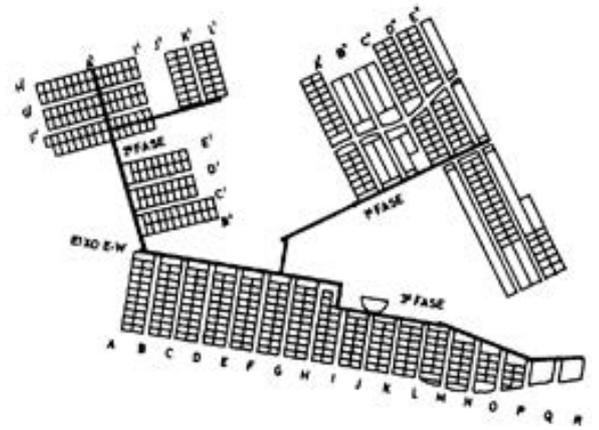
Planta da Malagueira, segunda versão publicada. Planta esquemática das fases do projecto
